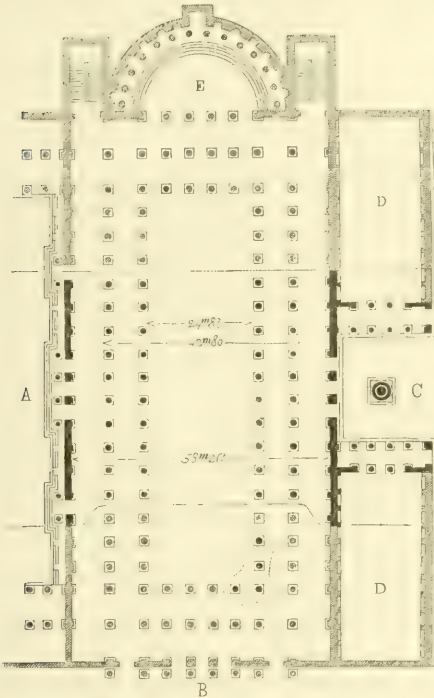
Grundriss der Basilica Ulpia.
